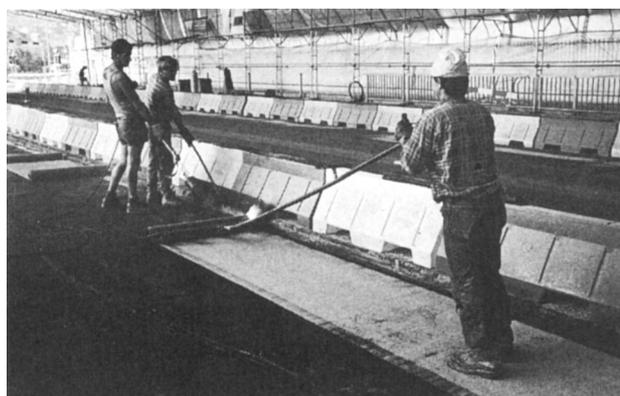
Esecuzione di una nuova impermeabilizzazione di un ponte (TIPB).
